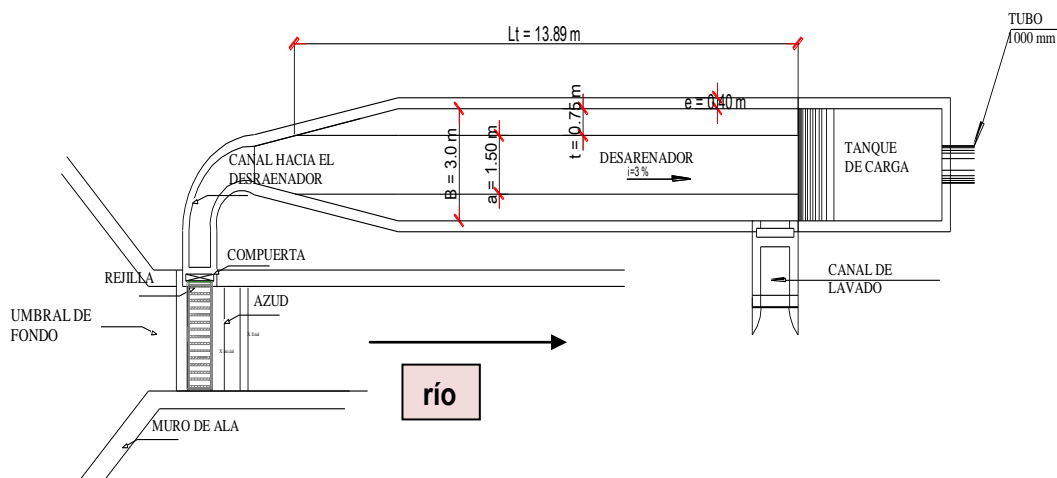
Desarenador vista en planta (Elaborado por Herrera Diego)
